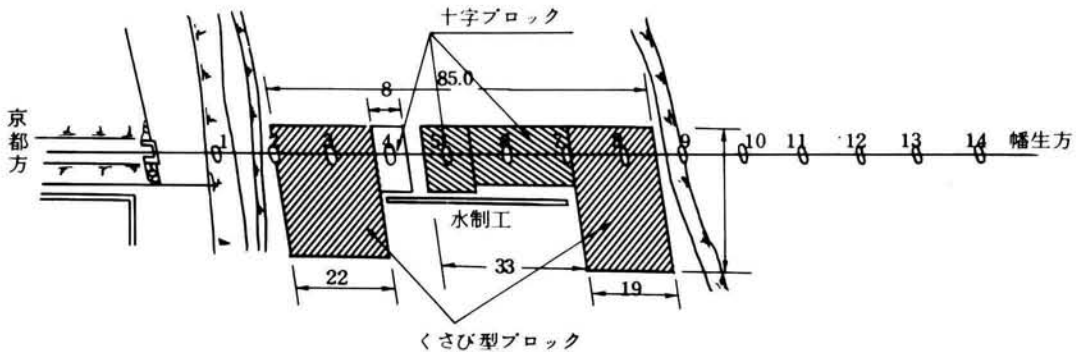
山陰本線養父～八鹿間大屋川橋りょう平面図
